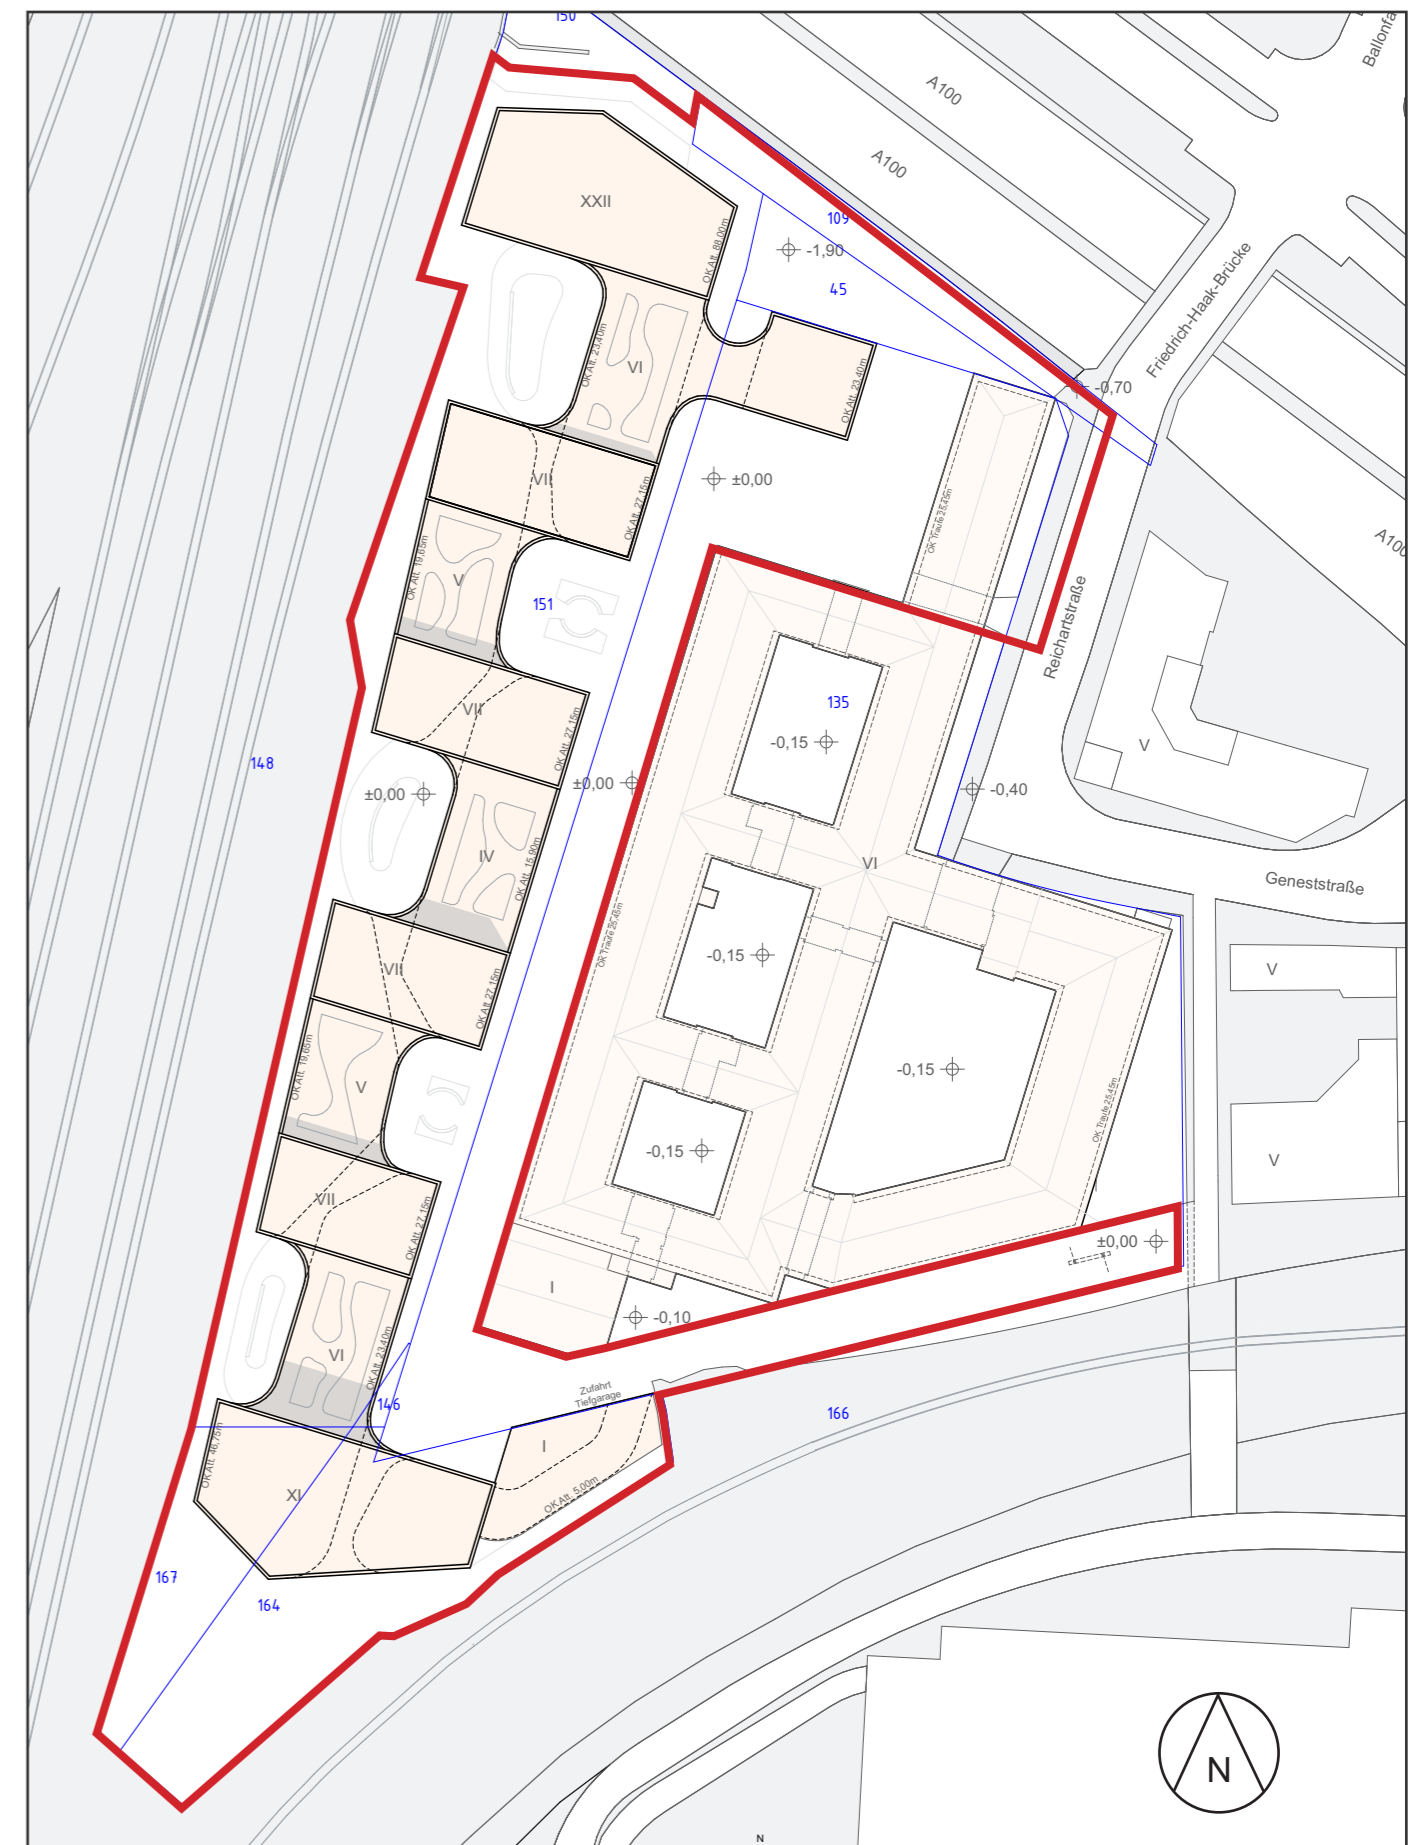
Lageplan mit Umgebung und Geltungsbereich (Stand März 2020)
